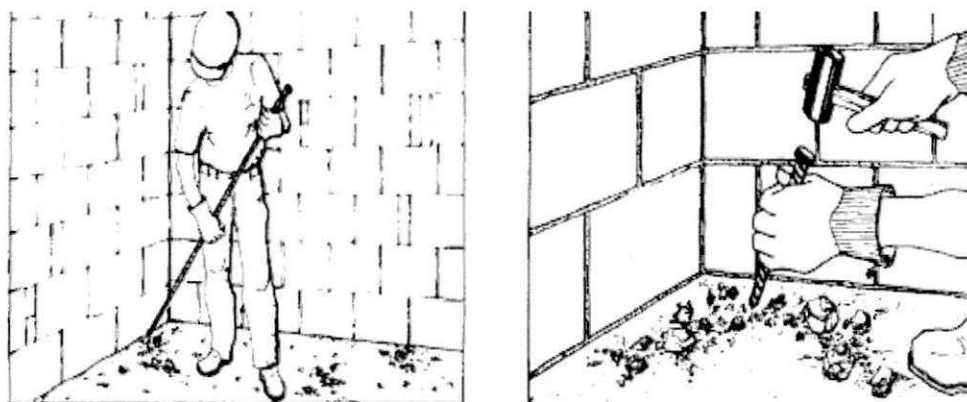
Remoção de detritos aderidos a laje utilizando um vanga ou ponteira e picão e marreta.
